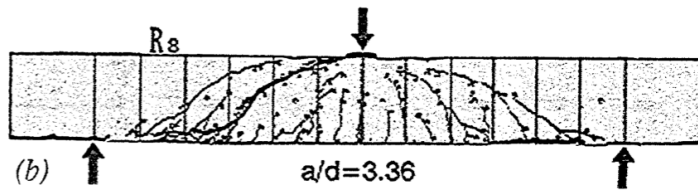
Patró de fissuració final de bigues d'assaig rectangulars esveltes amb estreps (Placas). Zararis, I.P; Karaveziroglou M.K y Zararis, P.D. "Shear strength of reinforced concrete T- beams". *ACI Structural Journal*, 2006, 103(5); 693-700.
